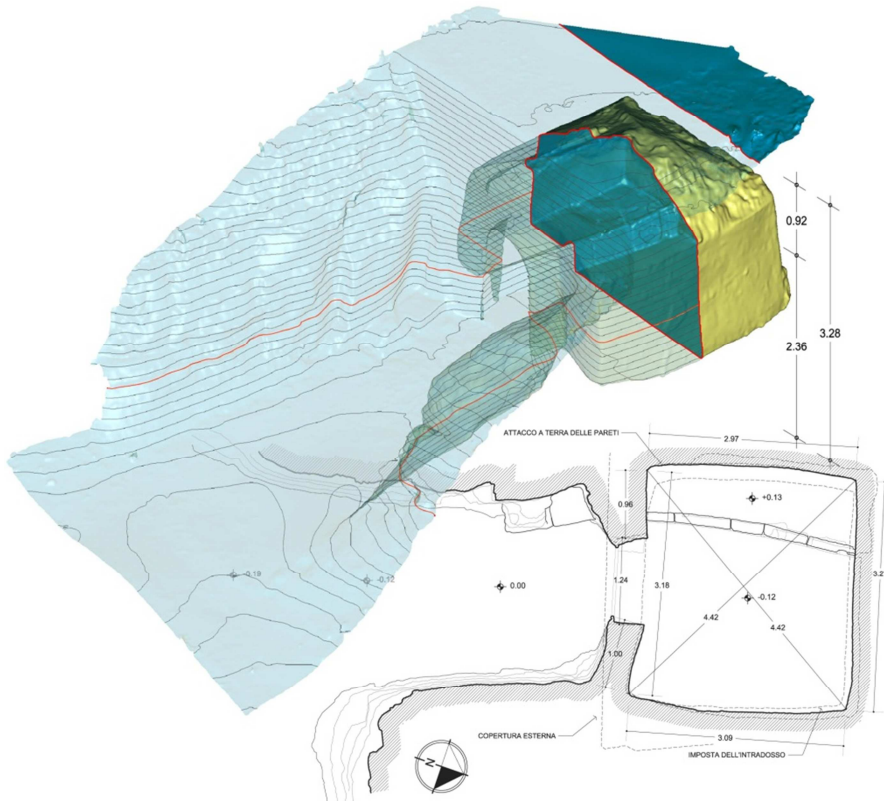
Tomba delle Anatre; sezione prospettica e pianta.
